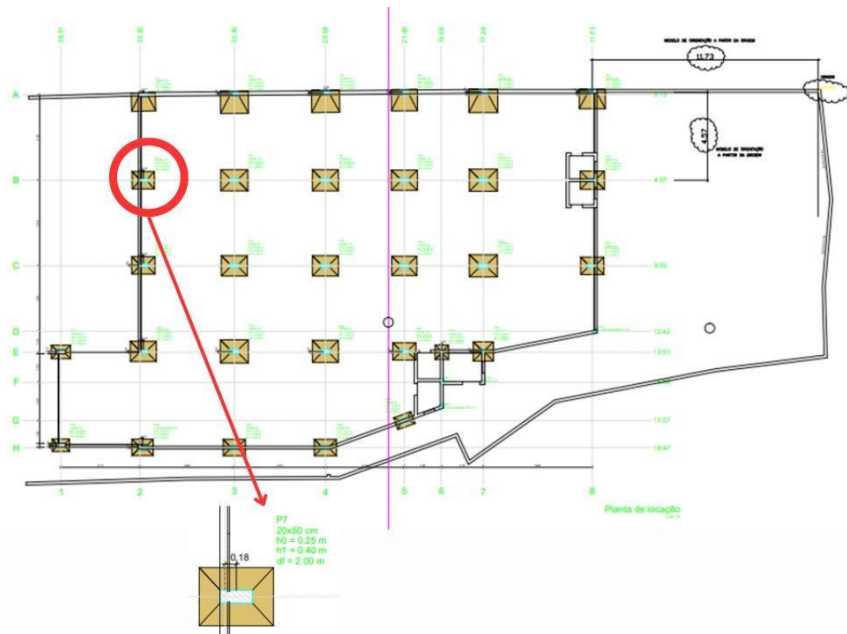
Planta de locação (Fornecido pela construtora, 2023)
